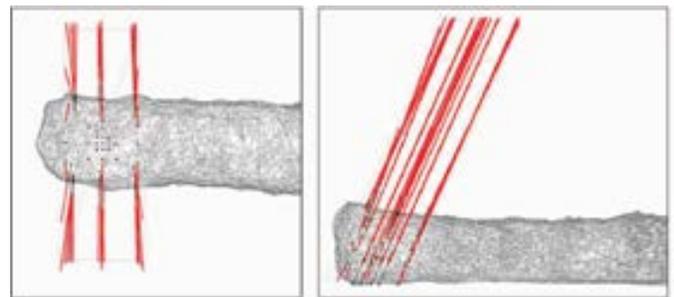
Esquema de cargado en rebaje ascendente. Vista en planta y transversal
